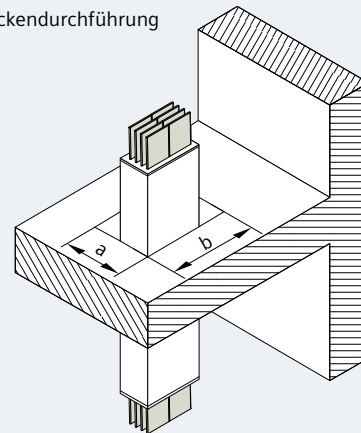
/10: Abstände der Schienenelemente zum Baukörper (Maße in mm)
